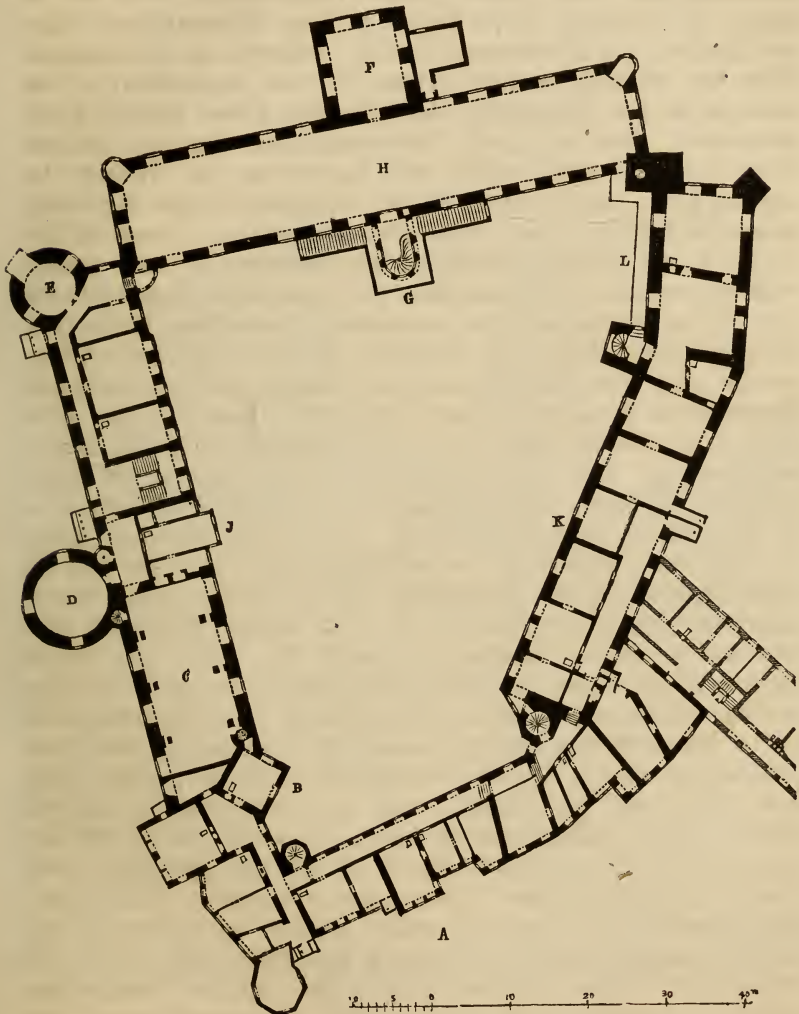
Schloss zu Torgau. Grundriss des I. Stocks.
